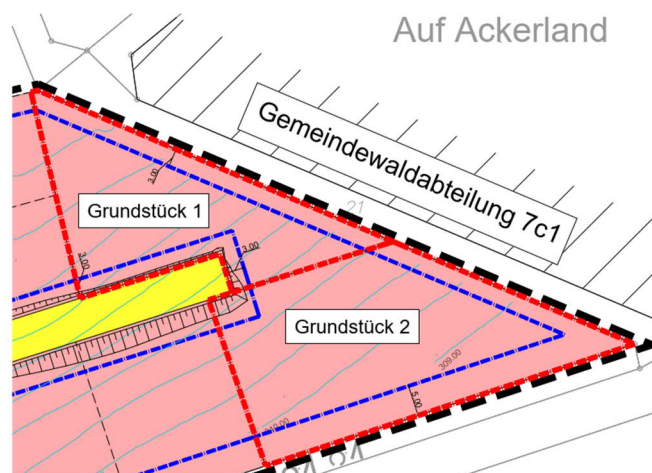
Lageskizze zur Identifikation der beiden von Windwurfgefahr betroffenen Wohnbaugrundstücke
